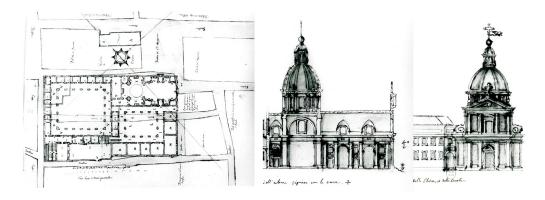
Chiesa di Santa Margherita, progetto di insieme di Agazio Stoia (1625): pianta del piano terra [penna e sanguigna, 46,5x35,5. Bibliothèque Nationale de Paris, Hd-4, 77, JVR 90] e progetto della chiesa in sezione e prospetto [stralci dai disegni JVR 90 e 95].
